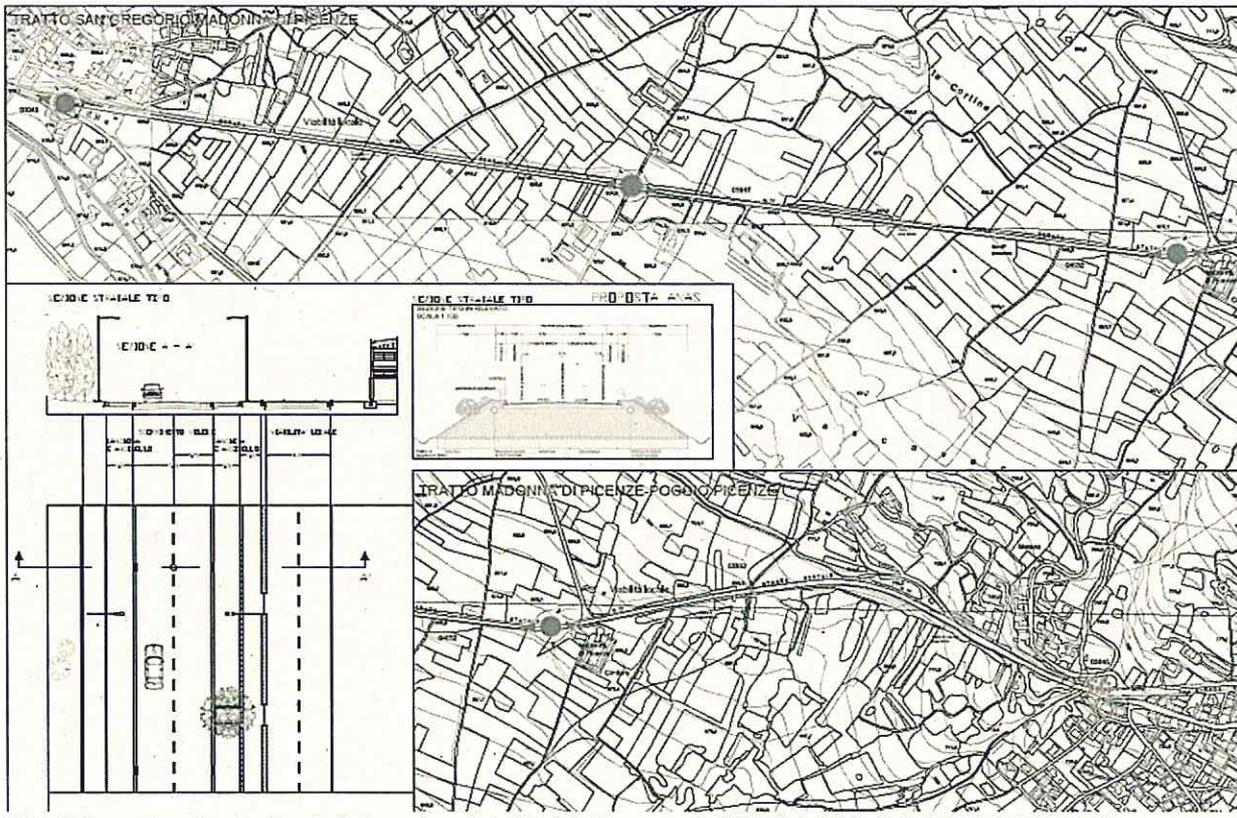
La planimetria dei Comitativi 1:2000 Tratto S.GREGORIO-POGGIO PICENZE, realizzata riportando le stesse sezioni di progetto -sezione strada tipo -proposta dall'ANAS-
